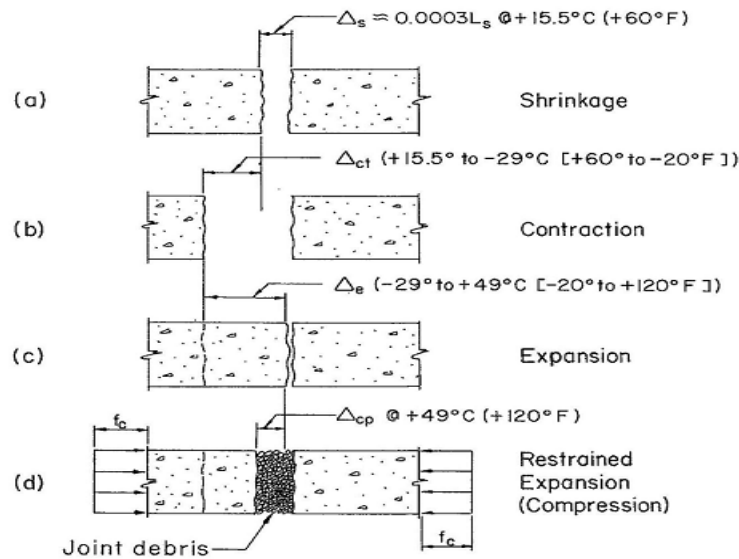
Riempimento delle fessurazioni della pavimentazione a causa dei detriti (Burke, 2009)
